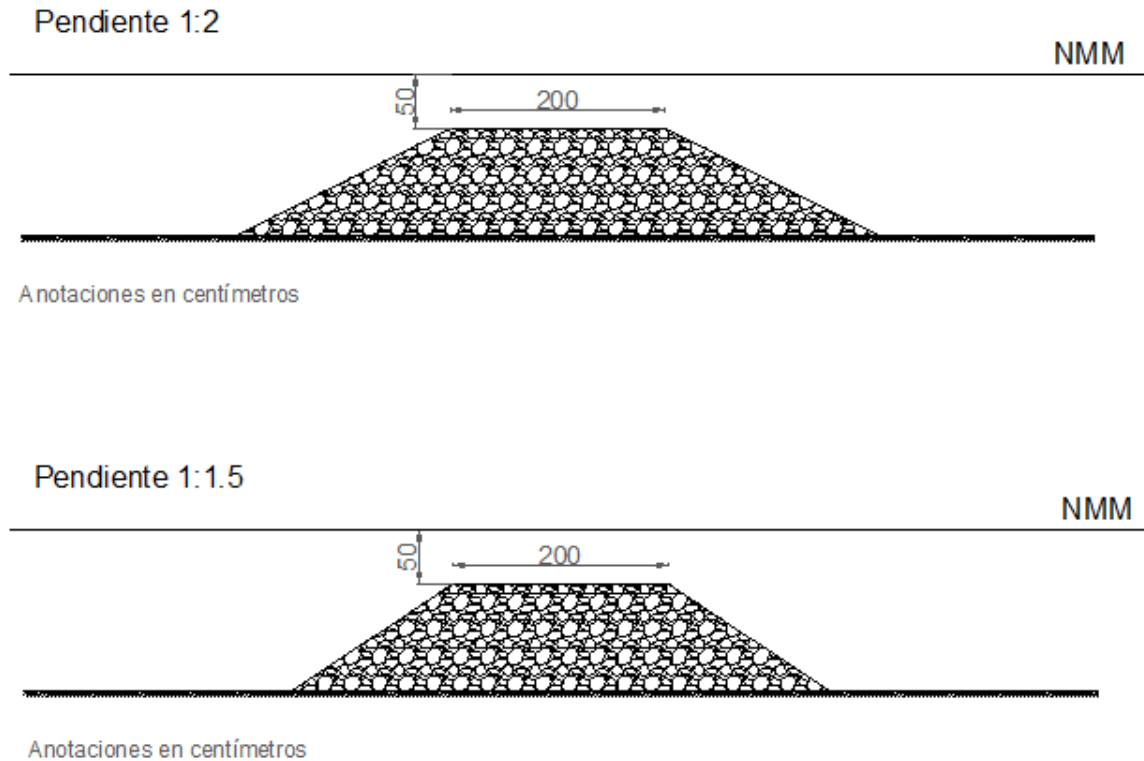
18 Secciones transversales de las propuestas de diseño estructural. Con pendiente 1:2 (arriba) y 1:1.5 (abajo)
